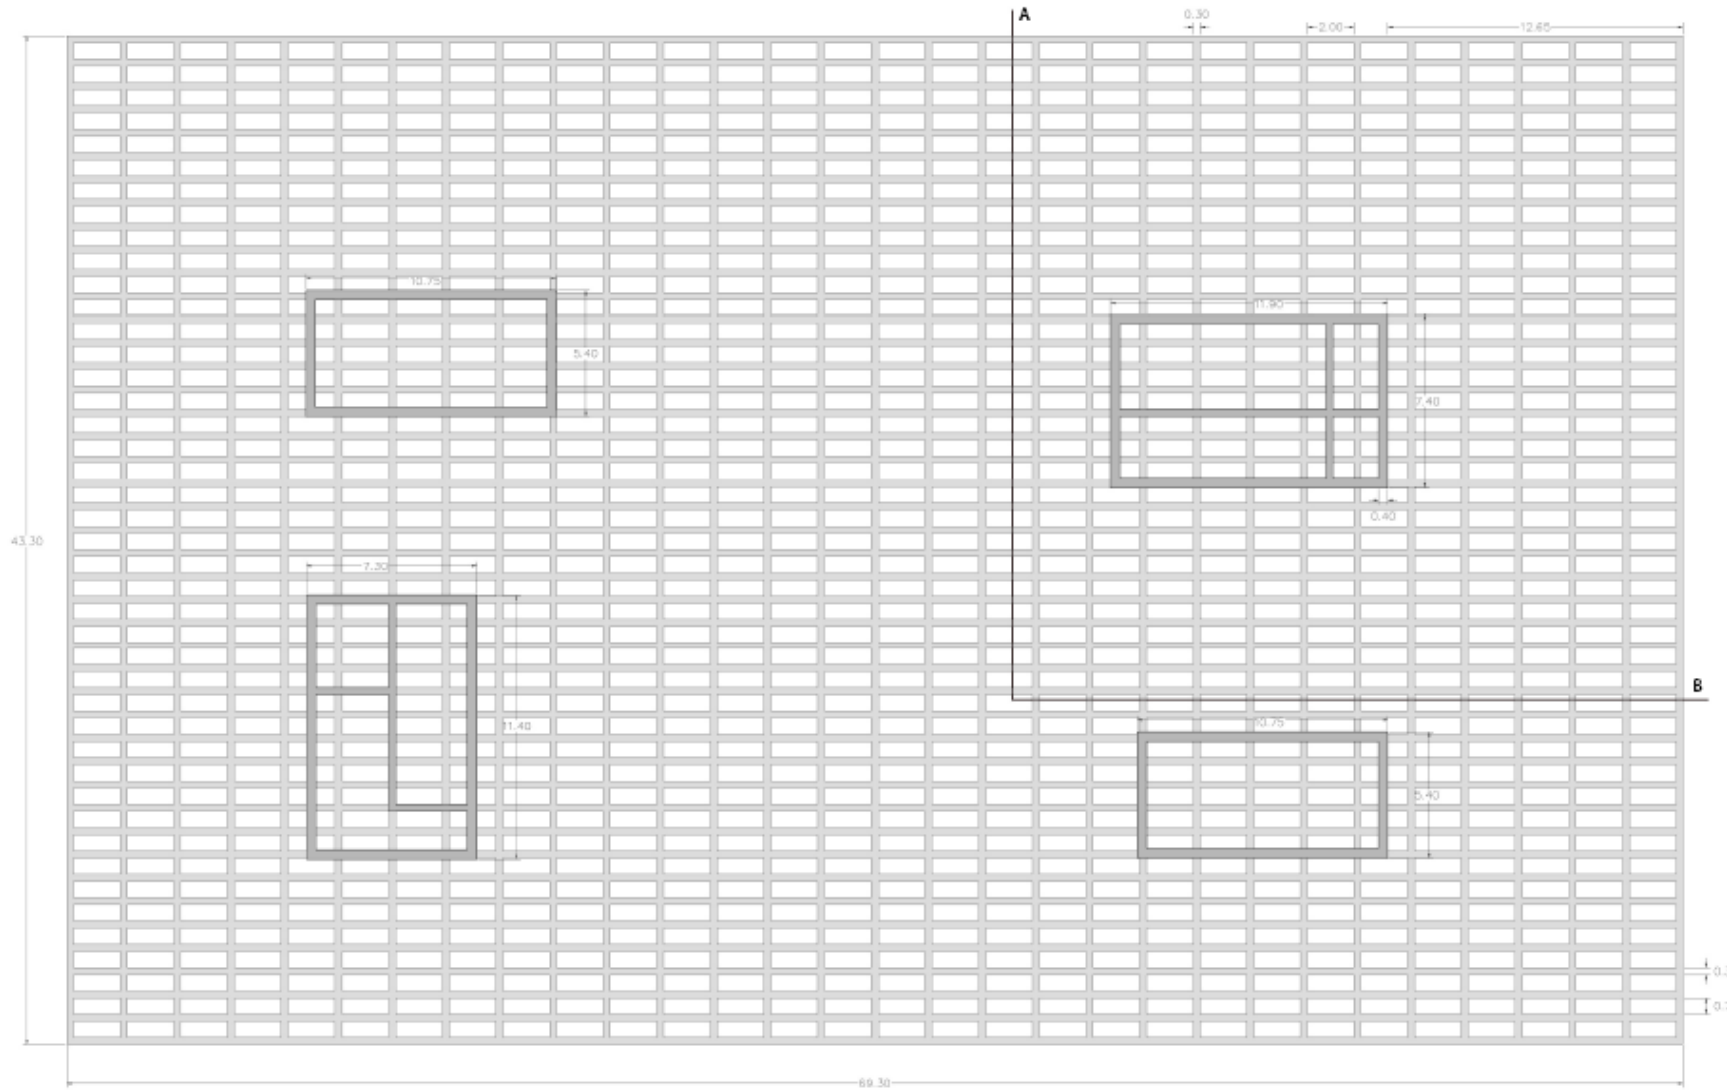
Forjado de la tercera planta del Veles e Vents
